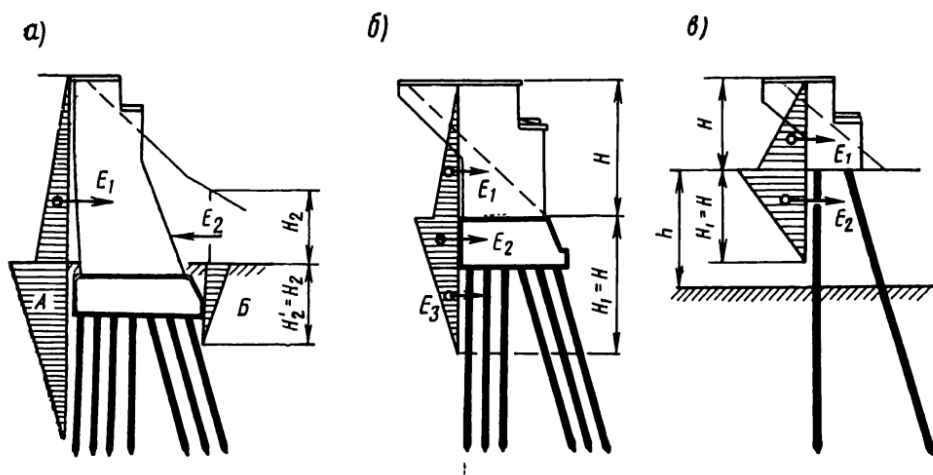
Схема эпюры бокового давления грунта насыпью
